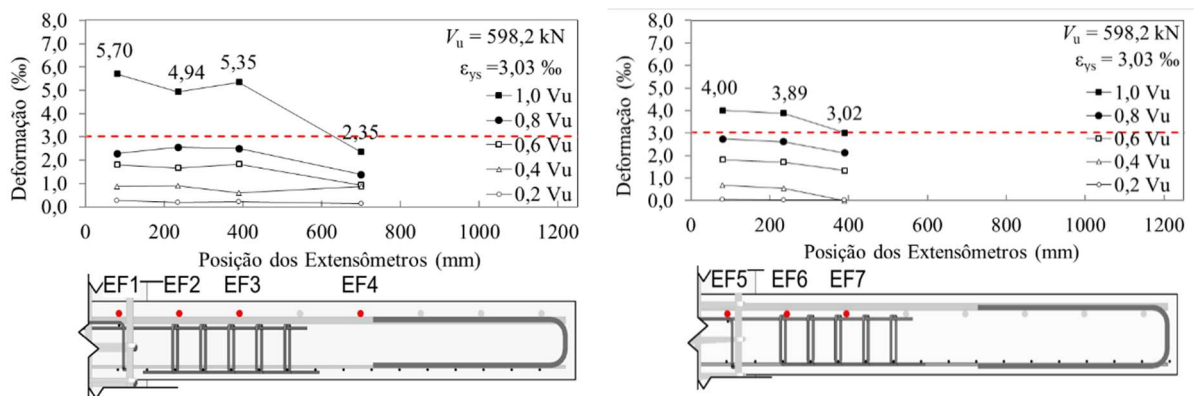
Deformações nas armaduras de flexão da laje CCA
